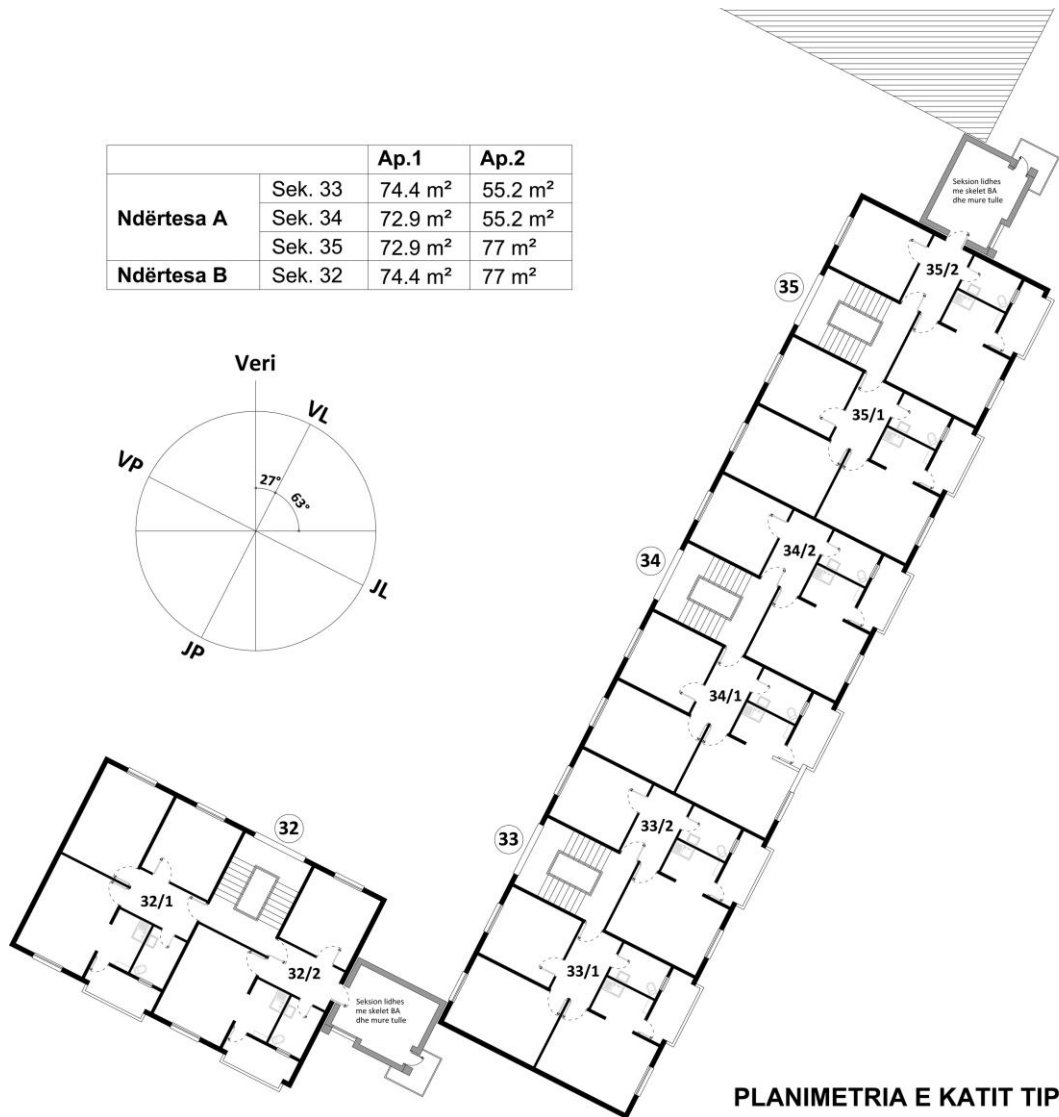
Planimetria e katit tip dhe sipërfaqet e apartamenteve në ndërtesat A dhe B
